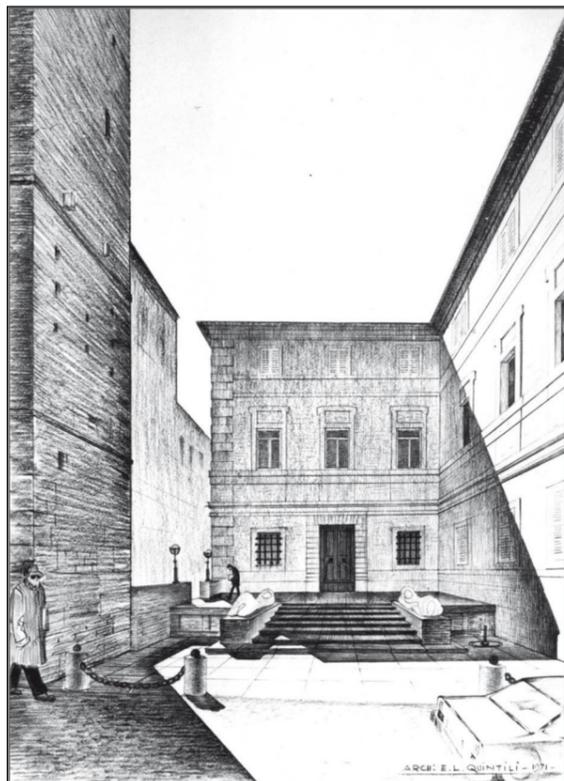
Proposta progettuale dell'architetto Quintili. Prospetto laterale sul corso.
